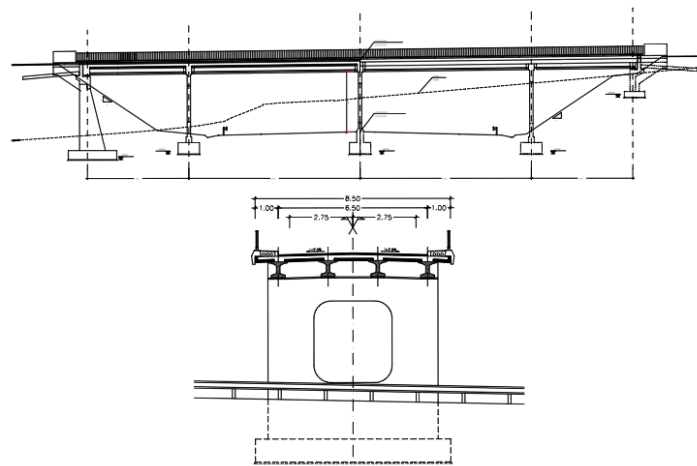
Solução de vigas em I usada na auto-estrada da Beira Interior
